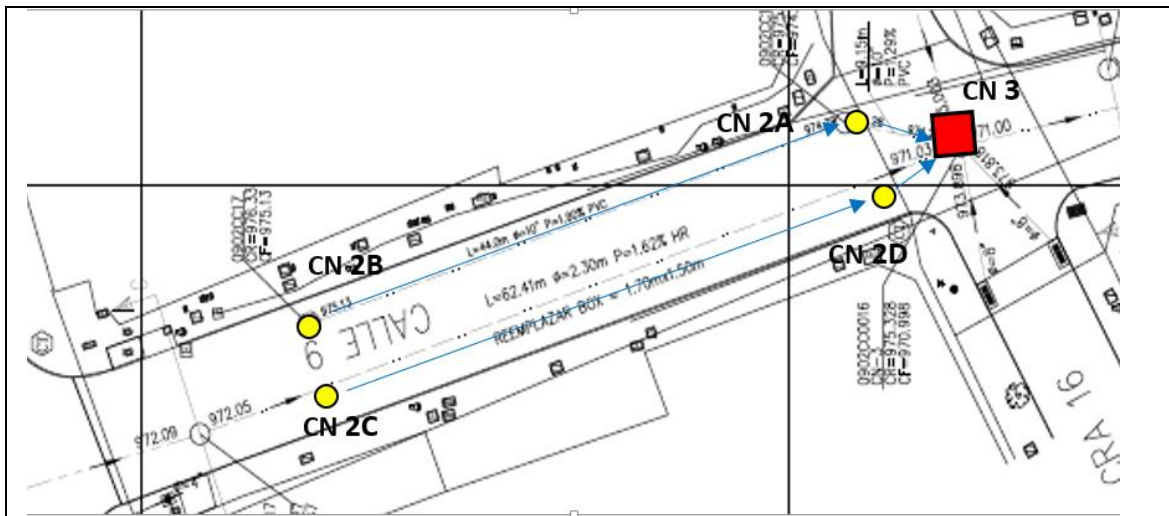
Instalación de tubería alcantarillado 10" en la calle 9 entre carrera 17 y 16.
